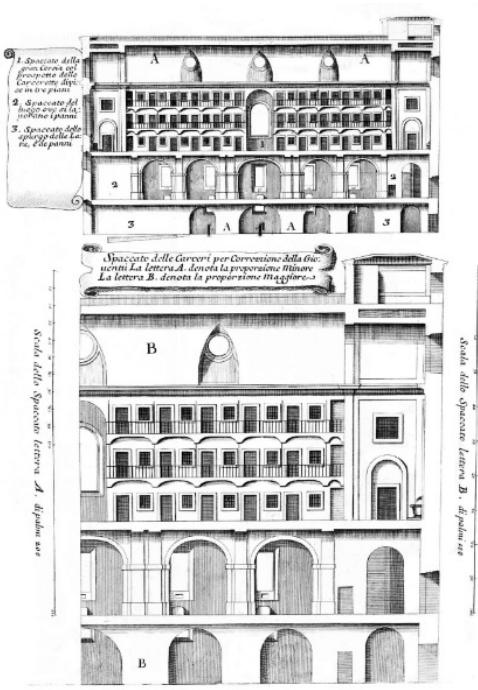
Casa de corrección de jóvenes de San Michele a Ripa. Roma. Planta y Sección longitudinal.PD.
